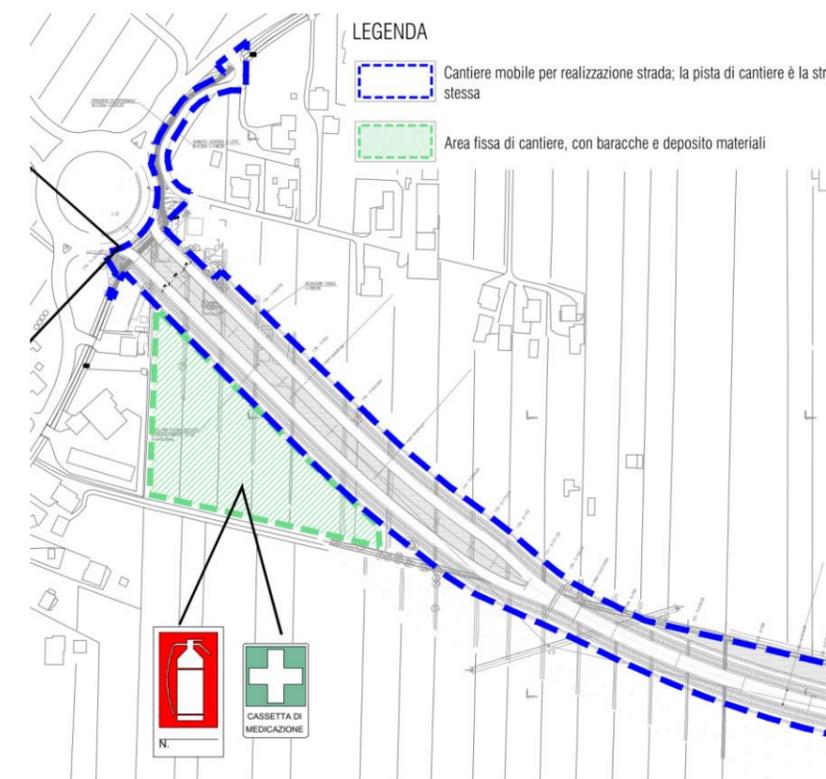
Planimetria raffigurante l'area fissa di cantiere prevista.
